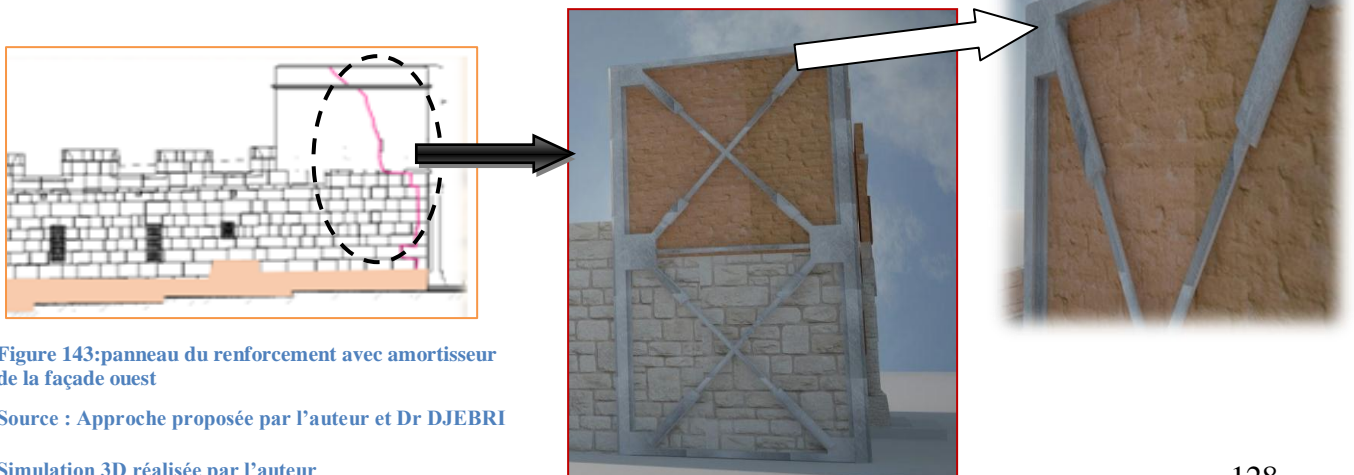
panneau du renforcement avec amortisseur de la façade ouest
